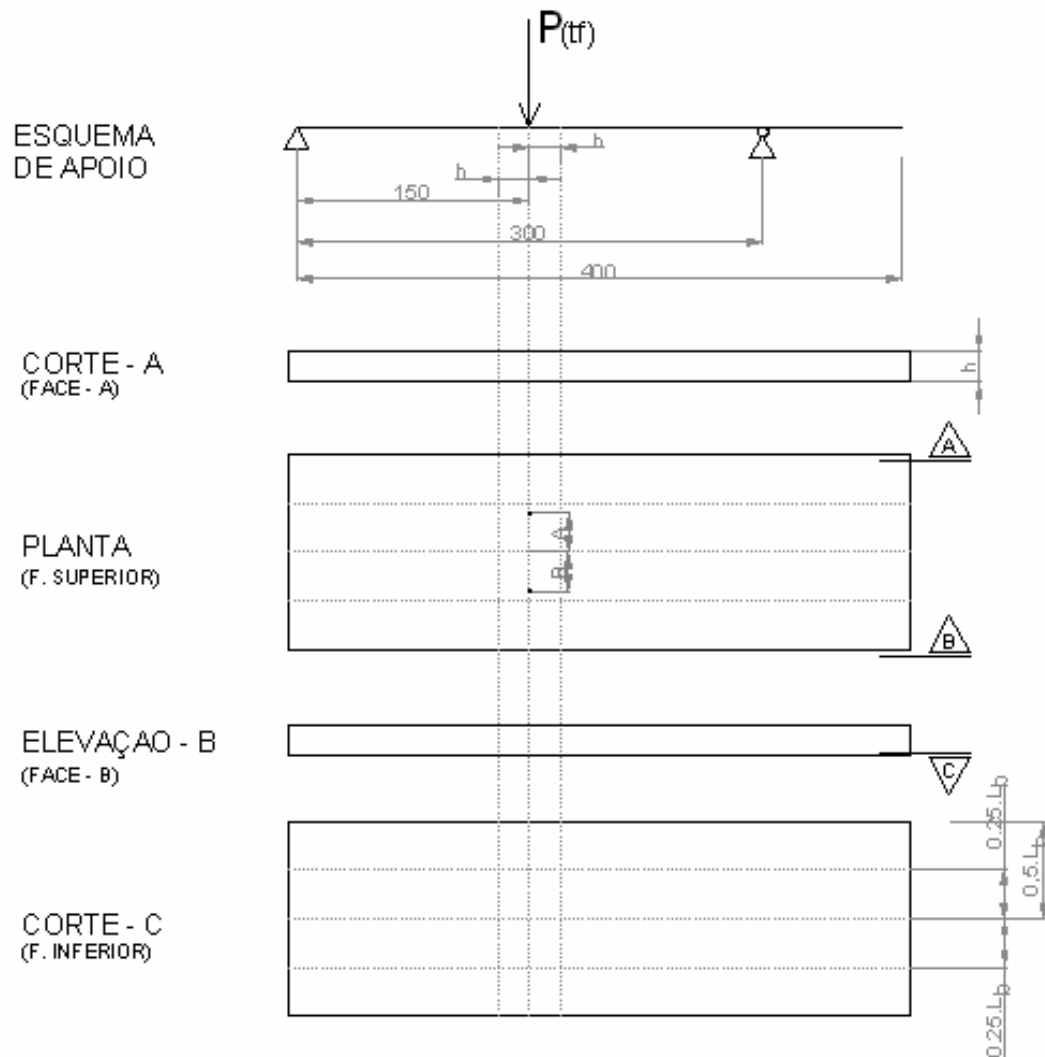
Indicação de fissuras (Fernandes, 2007)
